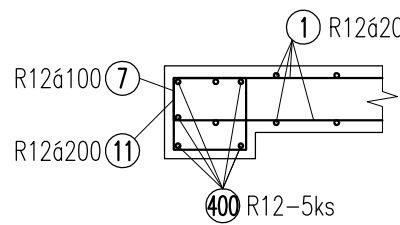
DETAIL VÝZTUŽE OZUBU SCHOD. RAMENE, M 1:25
